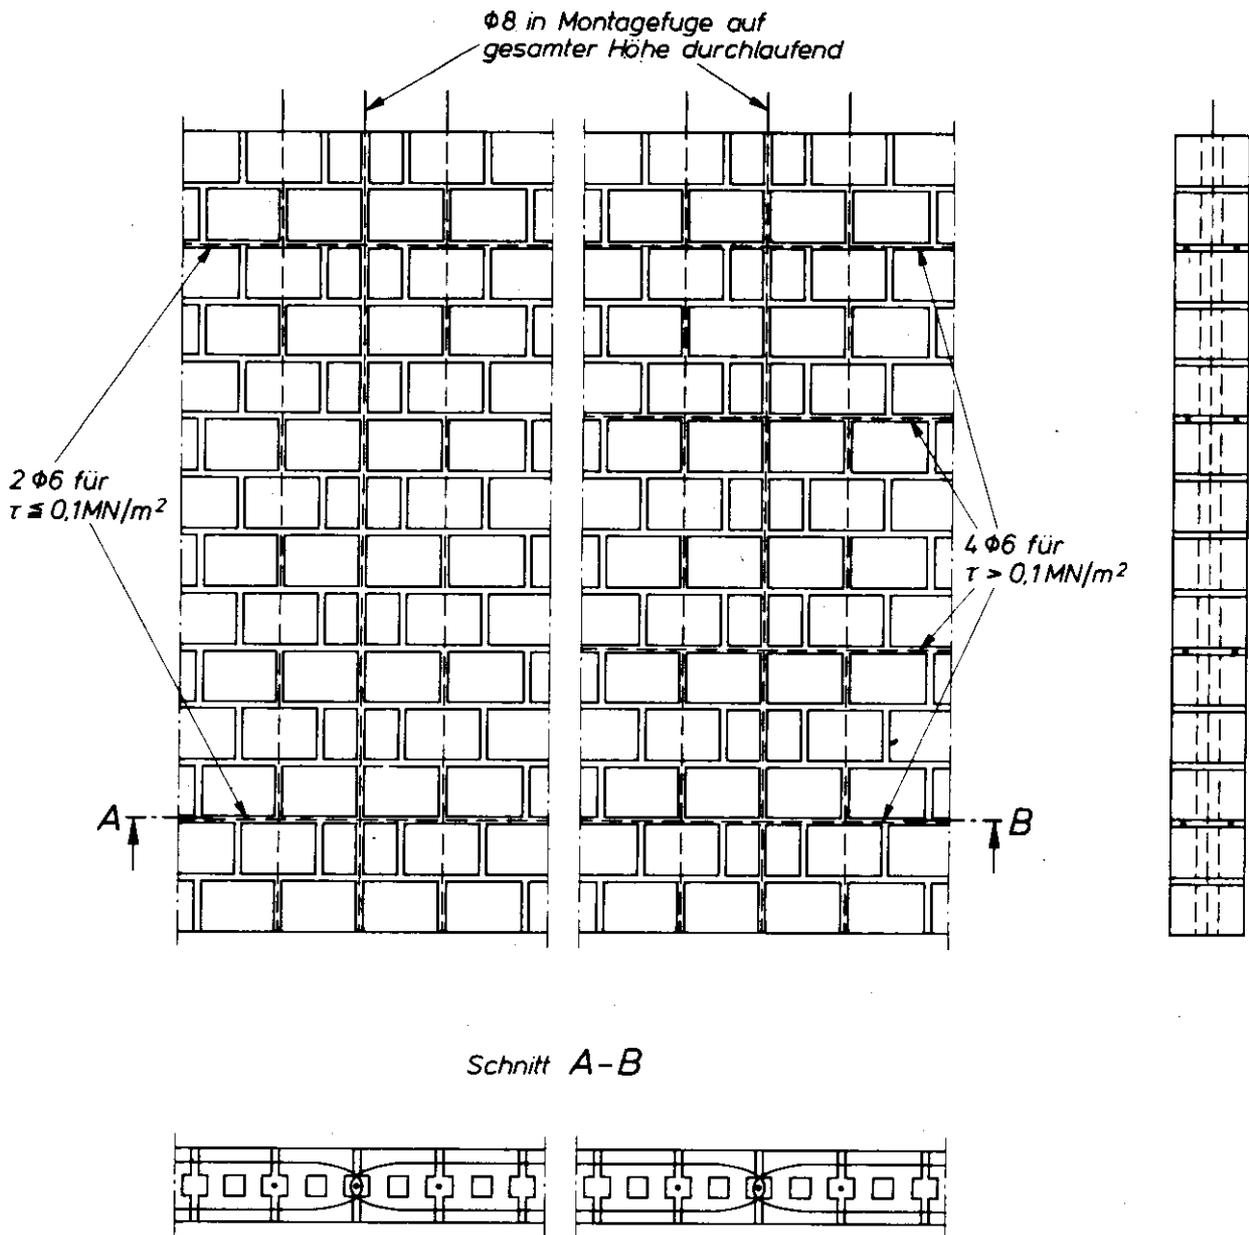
Schubfeste Verbindung von Mauertafeln. Konstruktive Schubbewehrung
